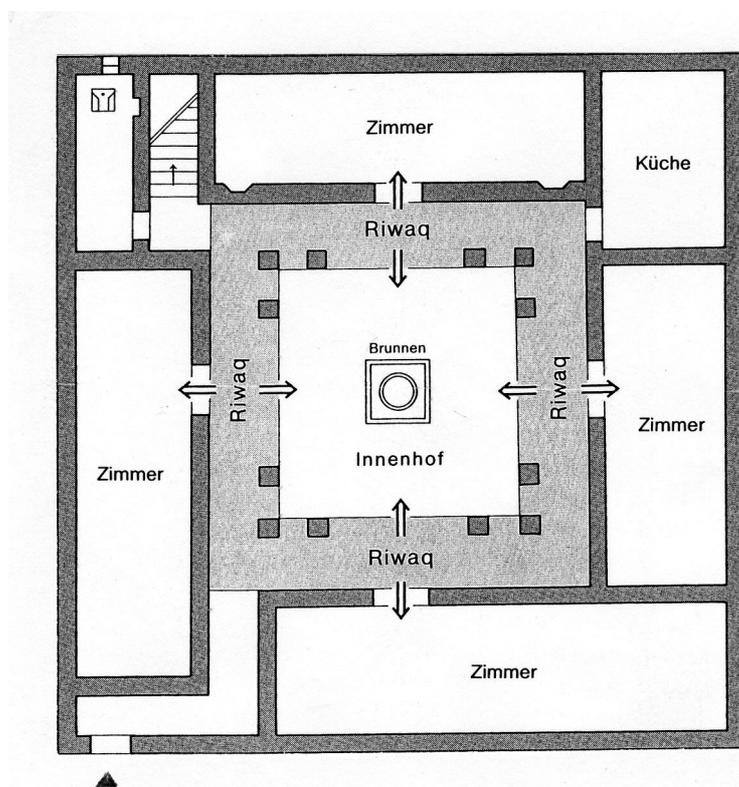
Grundriss eines traditionellen Wohnhauses in *Fās al-Bālī
